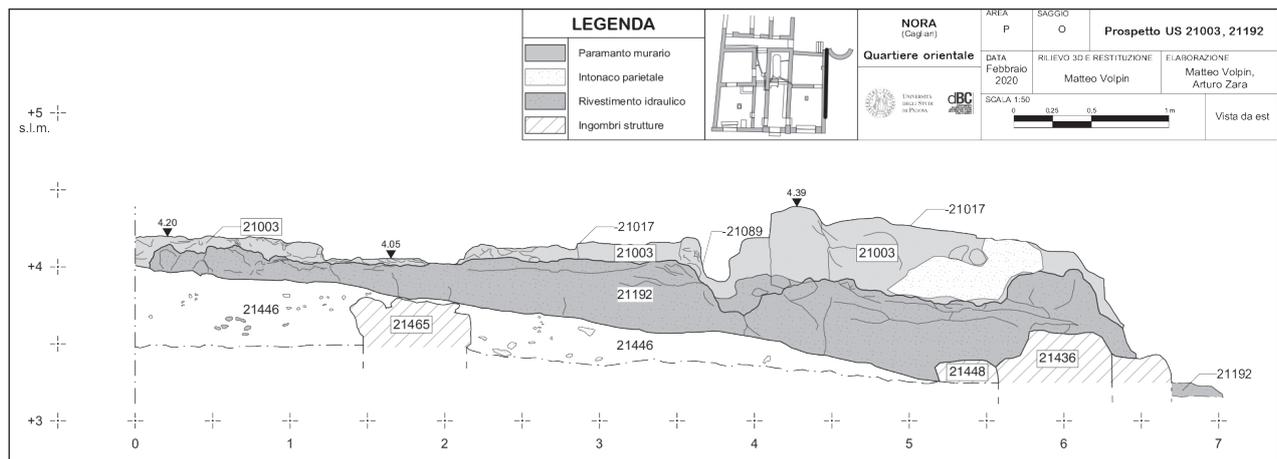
Nora, saggio PO. Prospetto della struttura US 21192 (fronte ovest).
